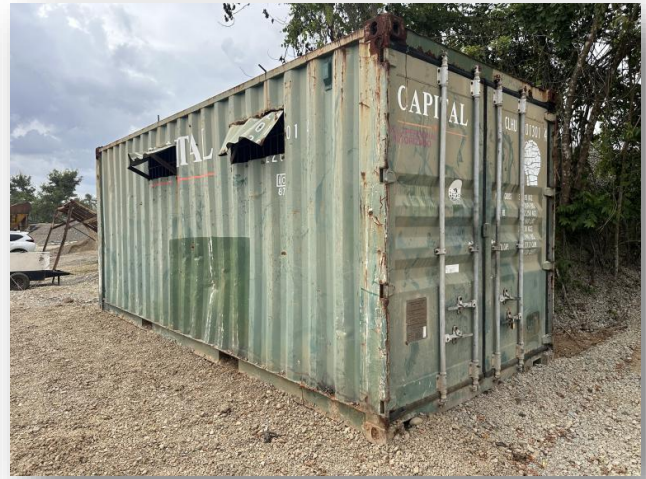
, Imagen 8 y Imagen 9.- Vistas de Planta generadora eléctrica, local del laboratorio y de equipos de la empresa.
